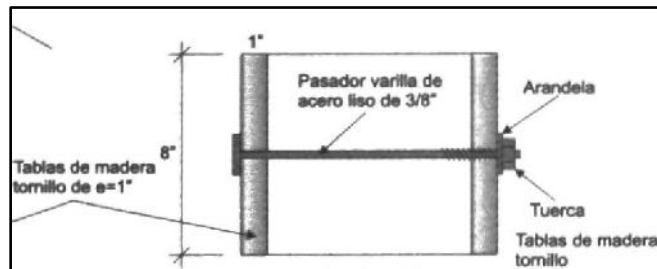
Detalle C: Pasador metálico (Kuroiwa, 2002)
